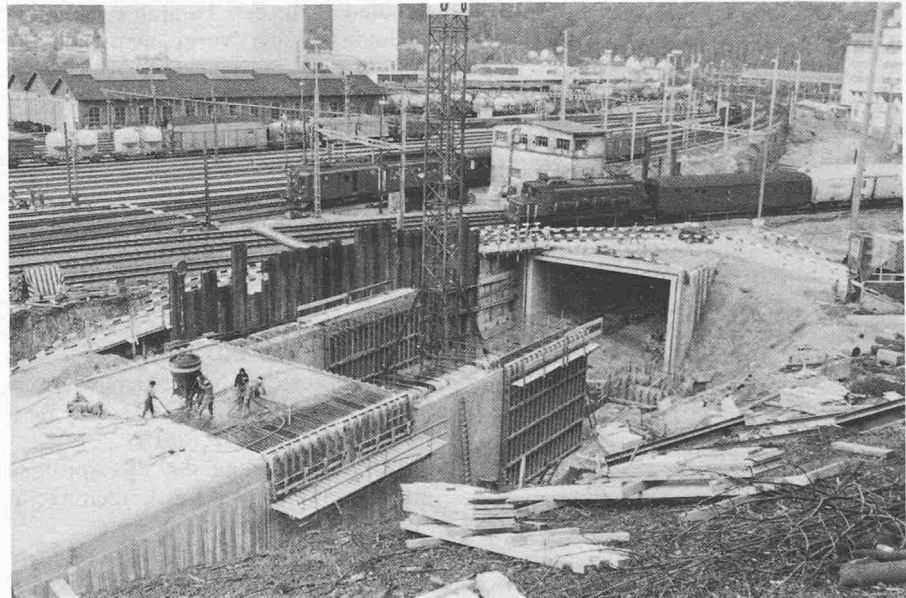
Tannwaldtunnel, vor dem Zusammenschluss mit dem Überwerfungsbauwerk Hangstrecke
